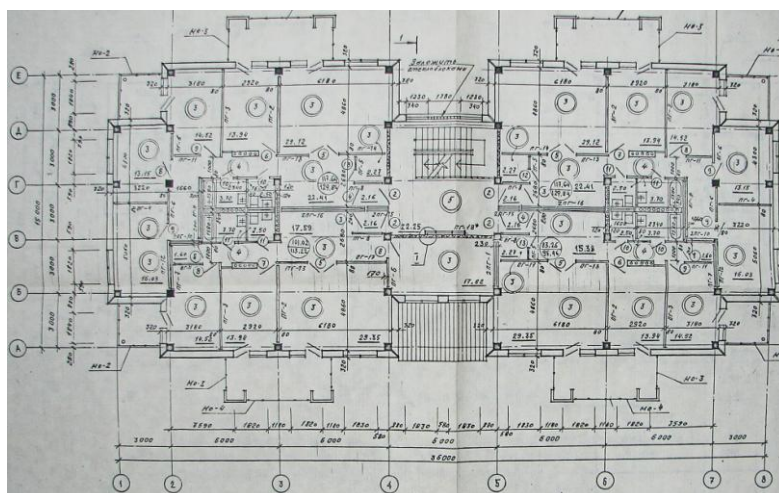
Чертеж типового этажа жилого дома по ул. Ботаническая, д. 1Е
